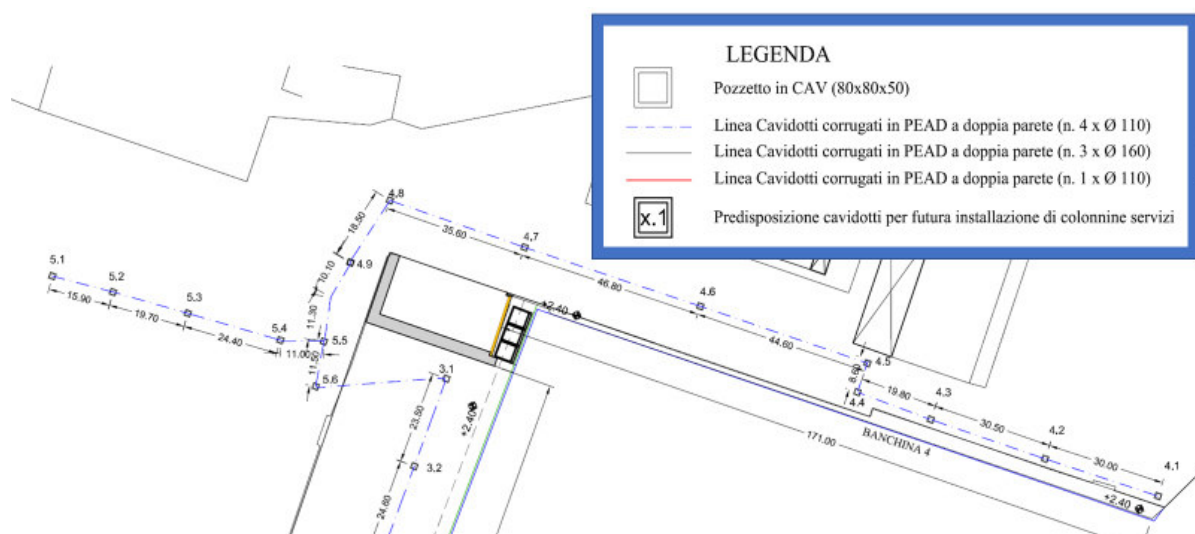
Stralcio planimetria EEG10016T2381/21- Piazzale IV Novembre e zona cabina CEB
